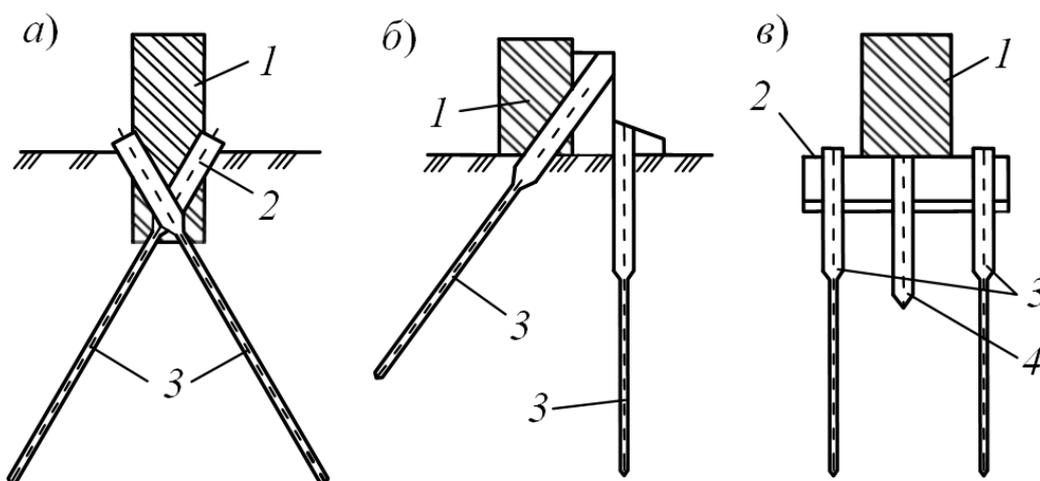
Варианты усиления фундаментов буронагнеточными сваями:
